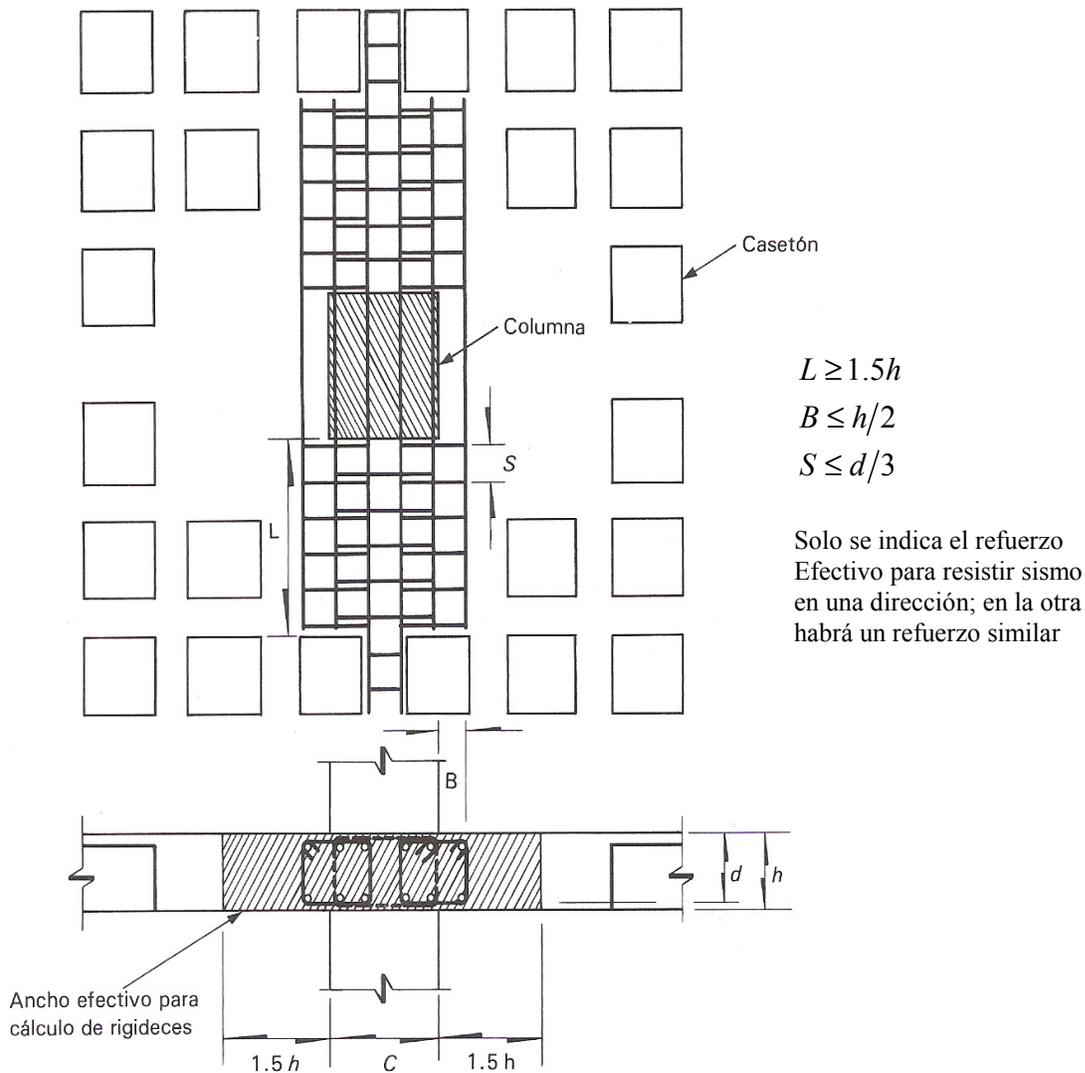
Refuerzo en la conexión viga - columna para resistir fuerzas sísmicas (necesario para adoptar $Q = 4$).
